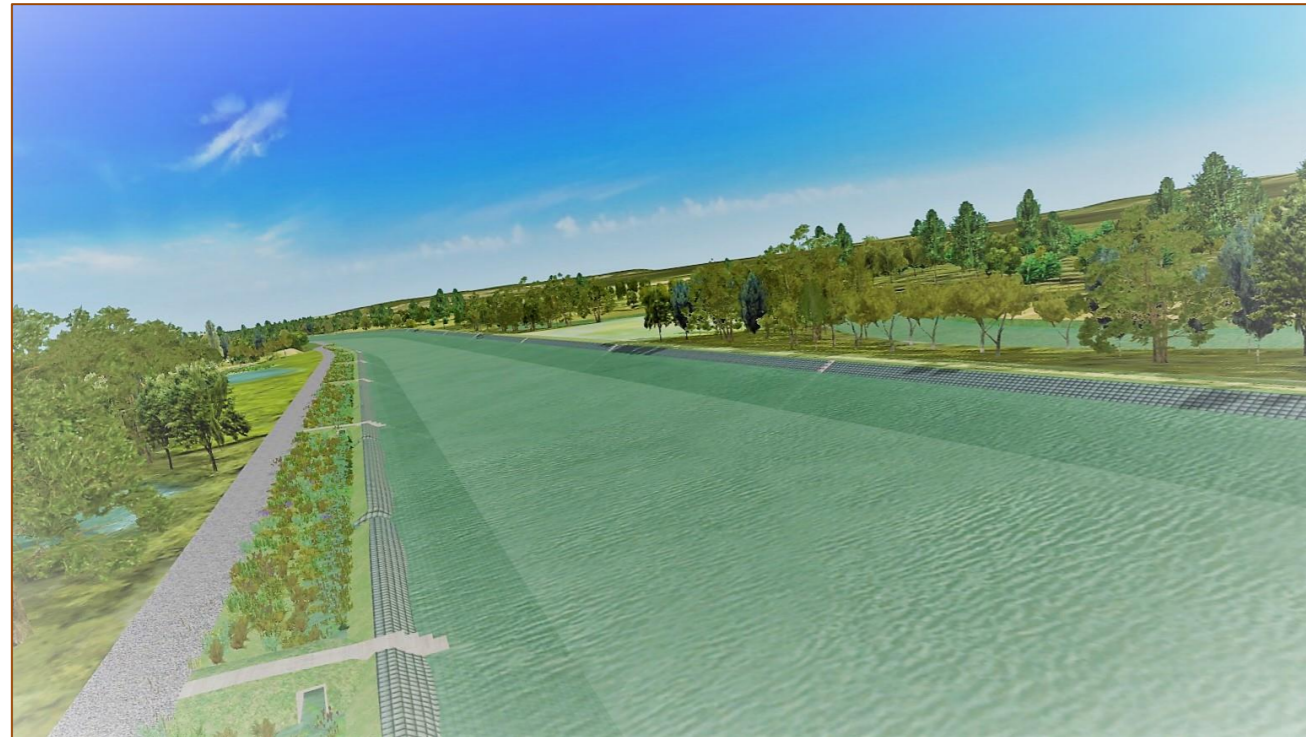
Bief 2. Site de Pimprez, avec l'Oise en arrière-plan
